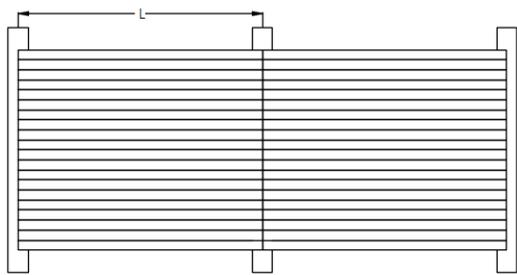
MLC tipo 1, laminaciones continuas con un solo apoyo
